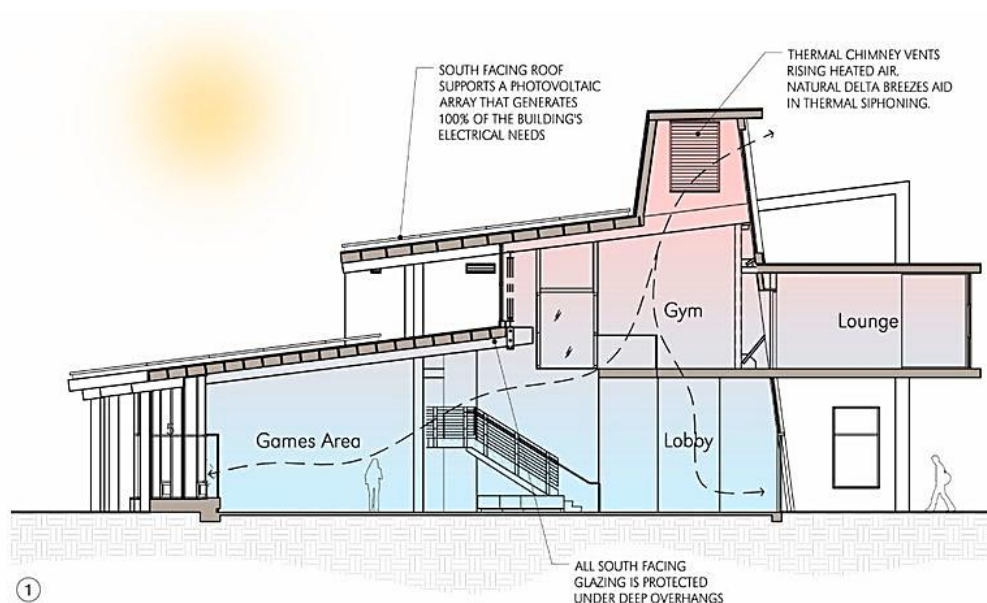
Sezione West village UC Davis, California [Fonte <https://www.archdaily.com/215764/uc-davis-west-village-studio-e-architects>]
